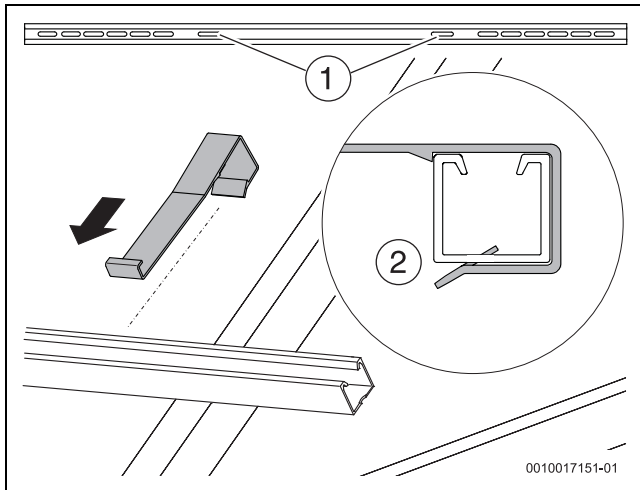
Montar as proteções contra deslizamento na calha de perfil inferior
